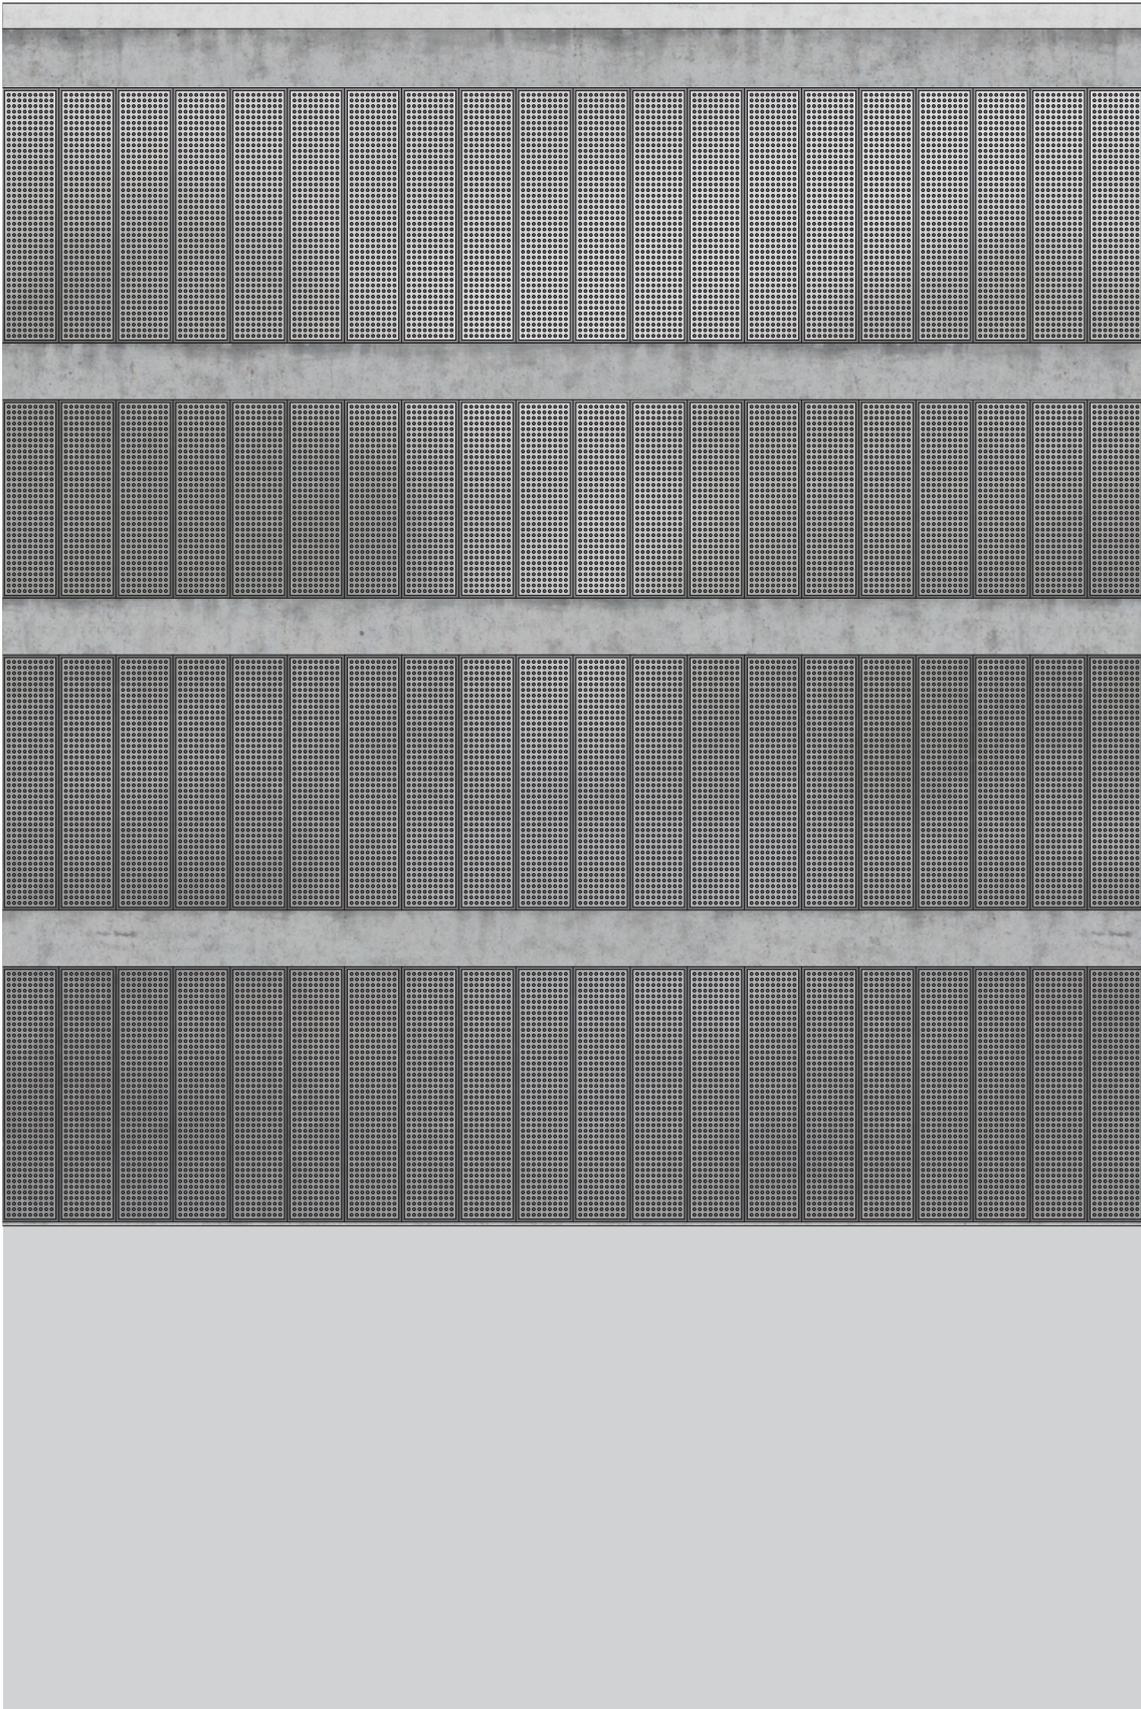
Werkhaus Fassadenschnitt - Ansicht
